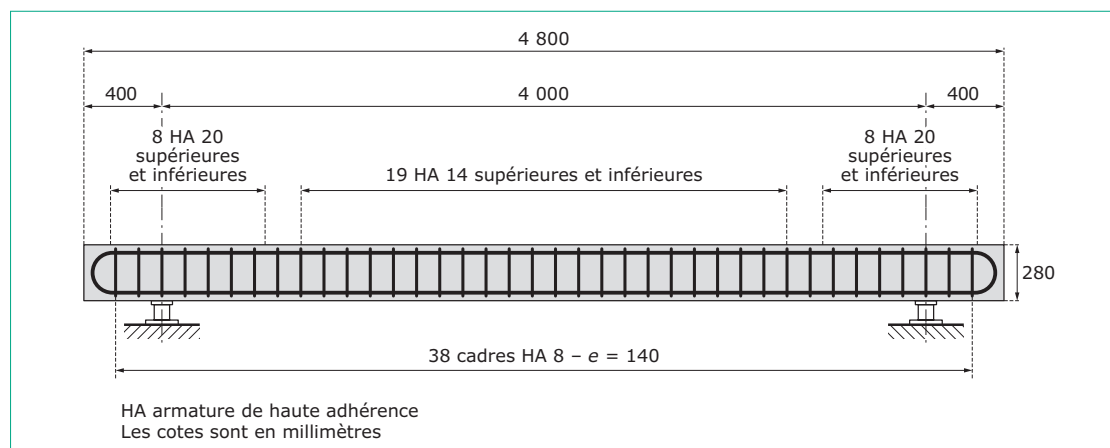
Coupe de la dalle d'essai dans le sens transversal
